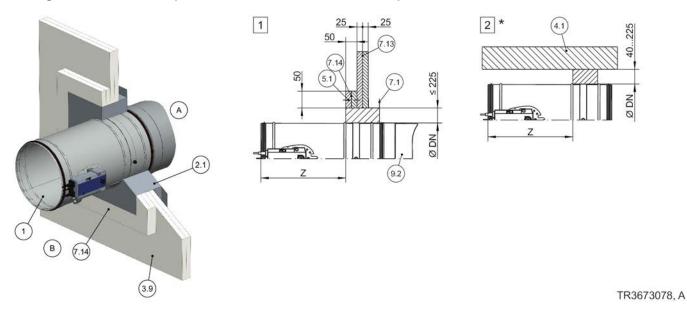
Montagem molhada numa parede de caixa sem estrutura de apoio de metal
